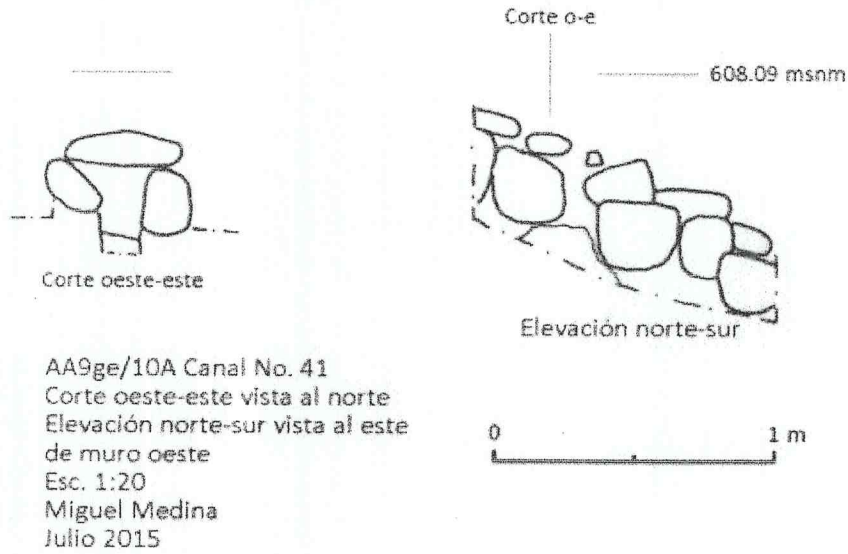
Corte oeste-este y elevación norte-sur del Canal No. 41.
